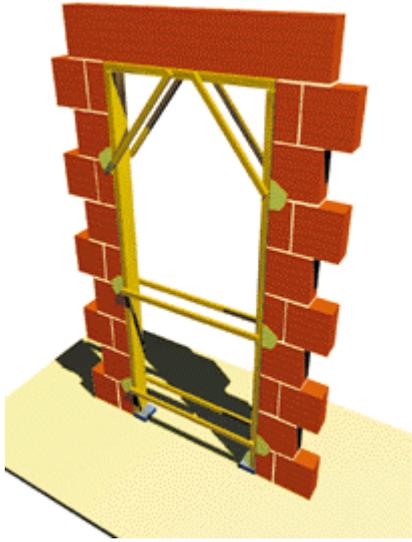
Realizzazione del vano porta con architrave in tavellone di laterizio. Montaggio del controtelaio tramite zanche. Si notino i distanziatori alla base del controtelaio, in corrispondenza dello spessore del massetto di pavimentazione.
